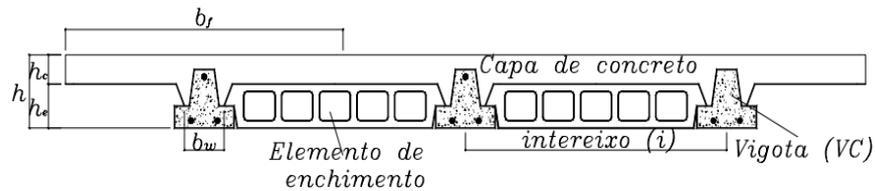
Corte esquemático de uma laje com vigotas do tipo trilho.
